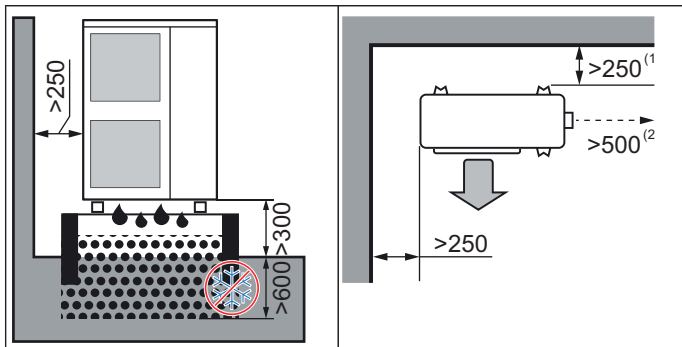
Vorderansicht Außengerät RRLQ auf Sockel
